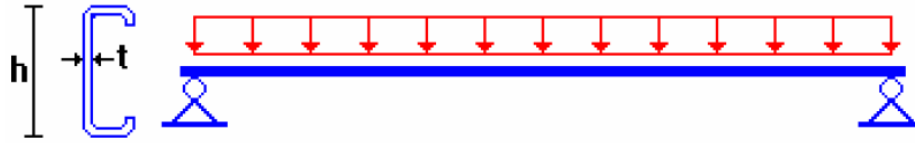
Viga sometida a carga distribuida con alas atiesadas
